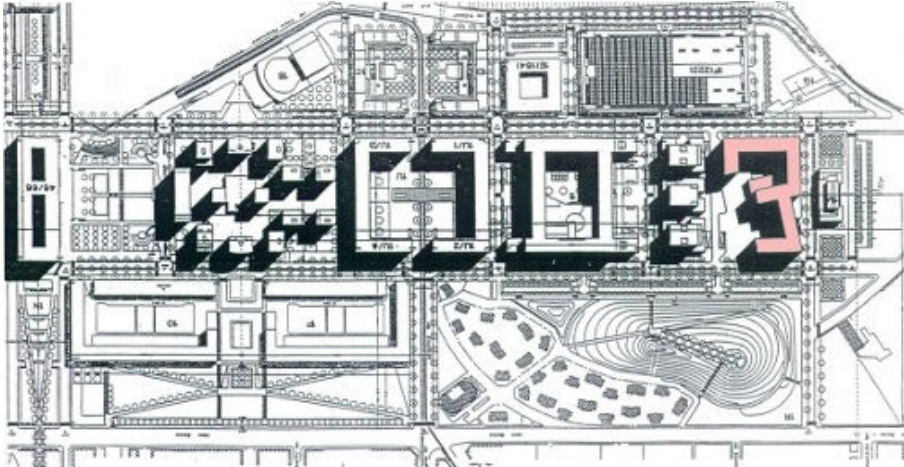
| Il masterplan del progetto “Bicocca” nella soluzione con la variante Deutsche Bank
